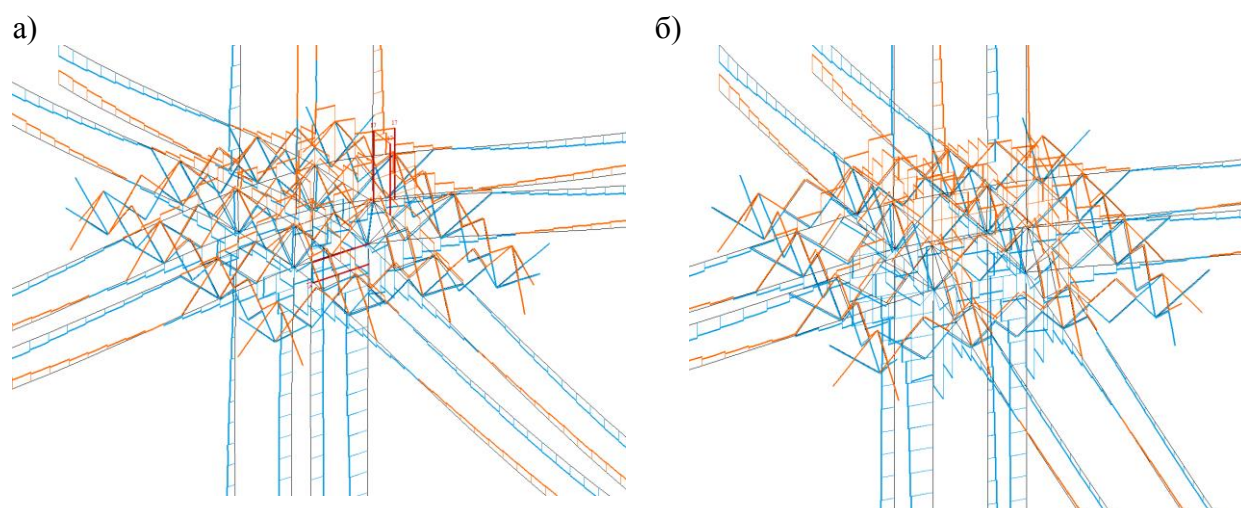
Распределение усилия N в арматурных стержнях в конструкции с применением наклонных стержней: а – по первичной схеме расчета; б – по вторичной схеме расчета
